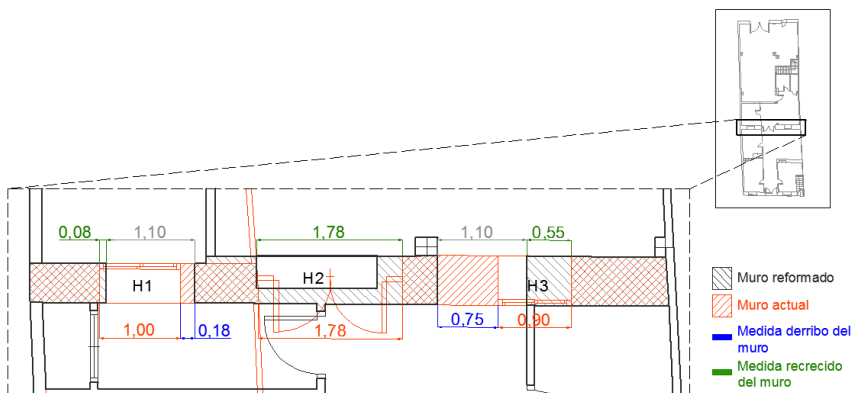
Superposición de los muros de carga de la vivienda de la planta baja. 2014. Elaboración propia.
